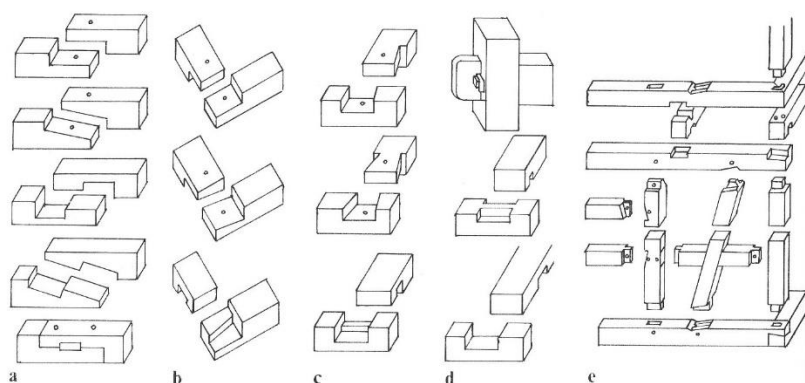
Uniões longitudinais, uniões perpendiculares em L, uniões perpendiculares em T, exemplo de conjunto de elementos construtivos (Benedetti & Bacigalupi, 1988).
